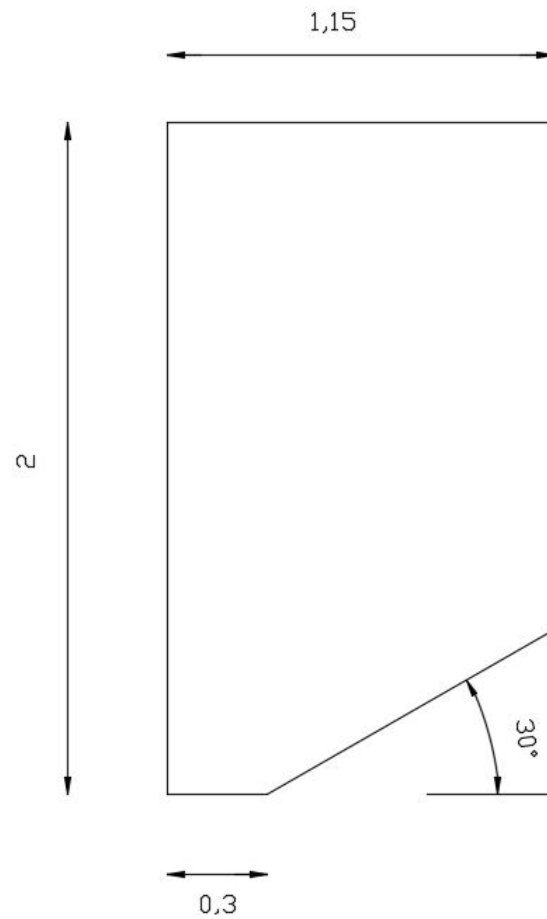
Perfil transversal del canal desarenador-desengrasador
